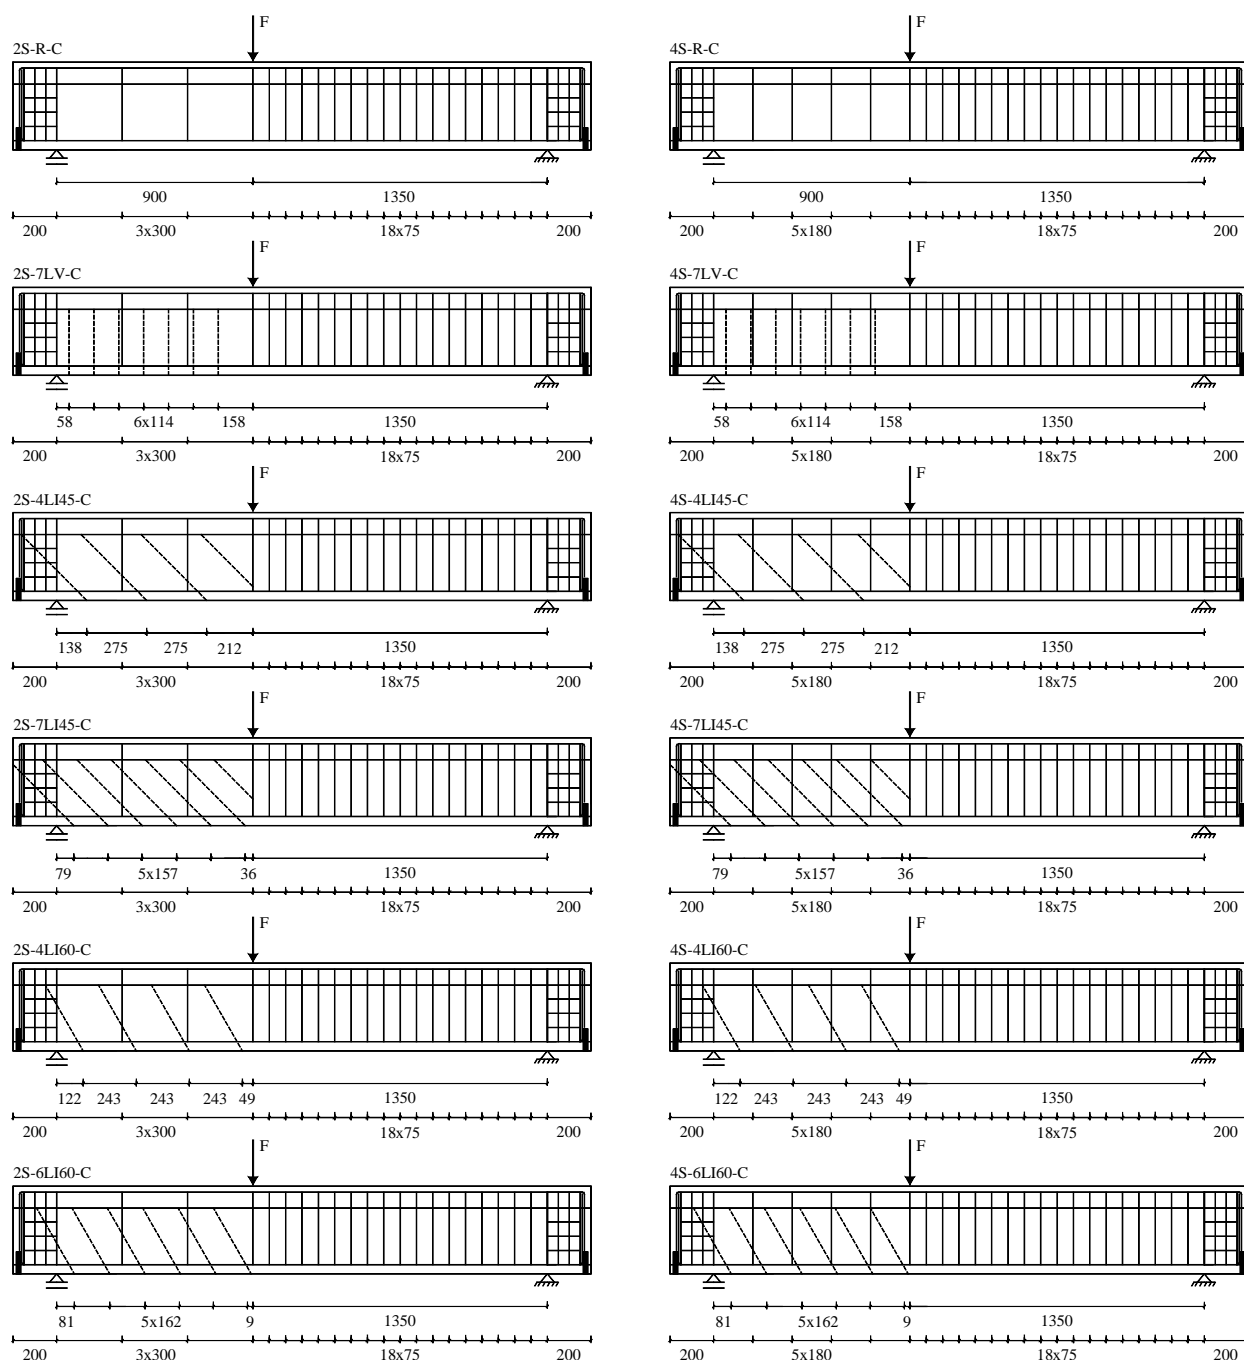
Vigas ensaiadas da série C: localização das armaduras transversais (linha a traço cheio) e dos laminados de CFRP no reforço ao corte (linha a tracejado).
